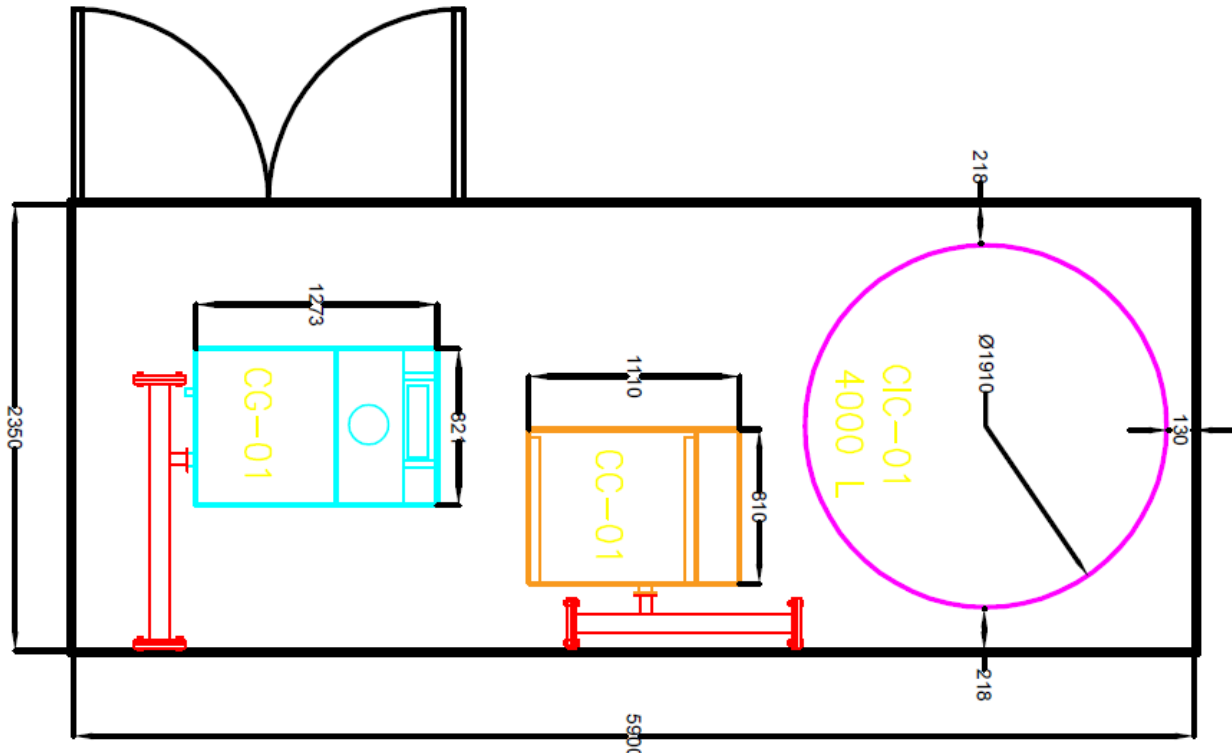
Layout de la sala de calderas de un proyecto residencial tipo
